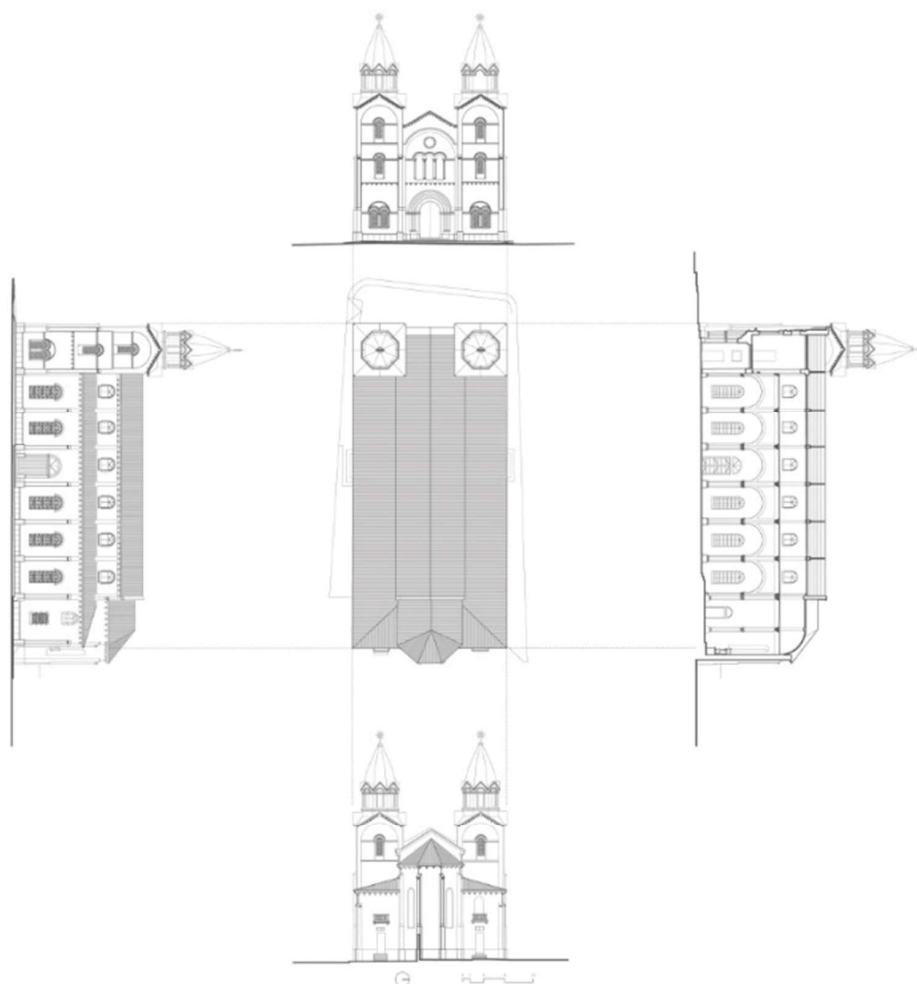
Planta cubierta y fachadas. Fuente: Orozco (2020).
